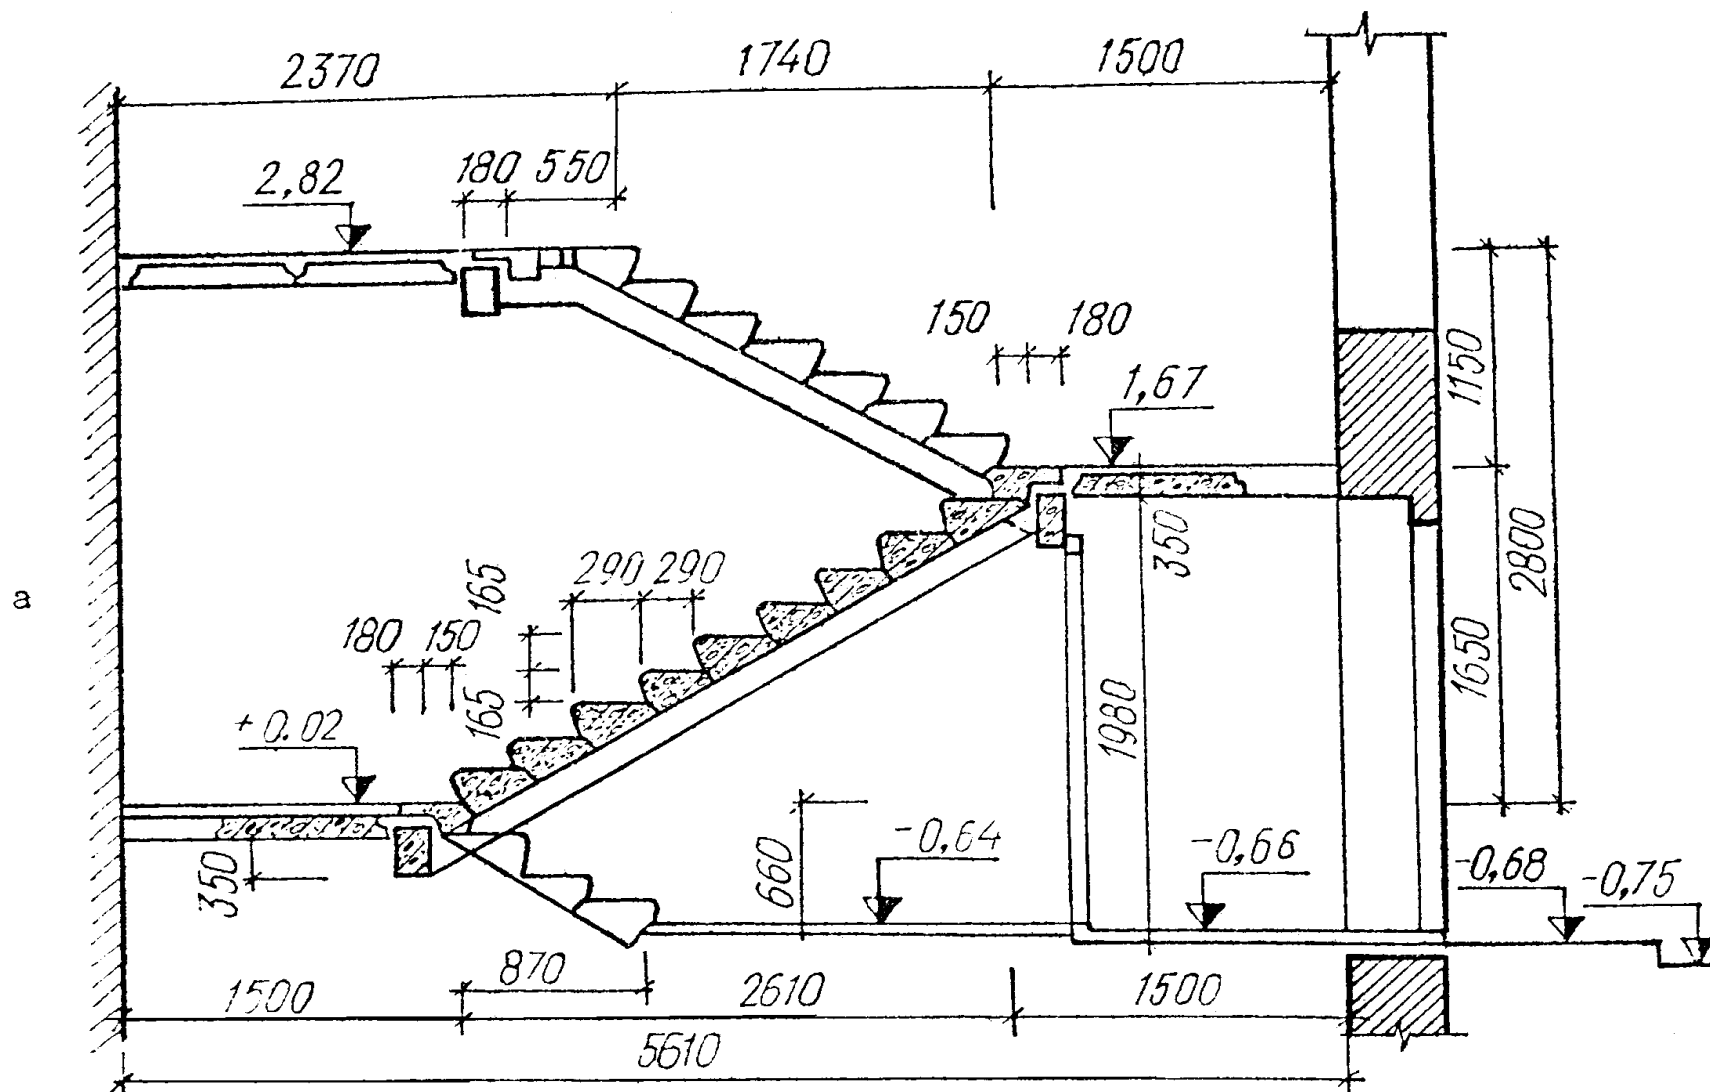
Сходи із збірних залізобетонних елементів:
